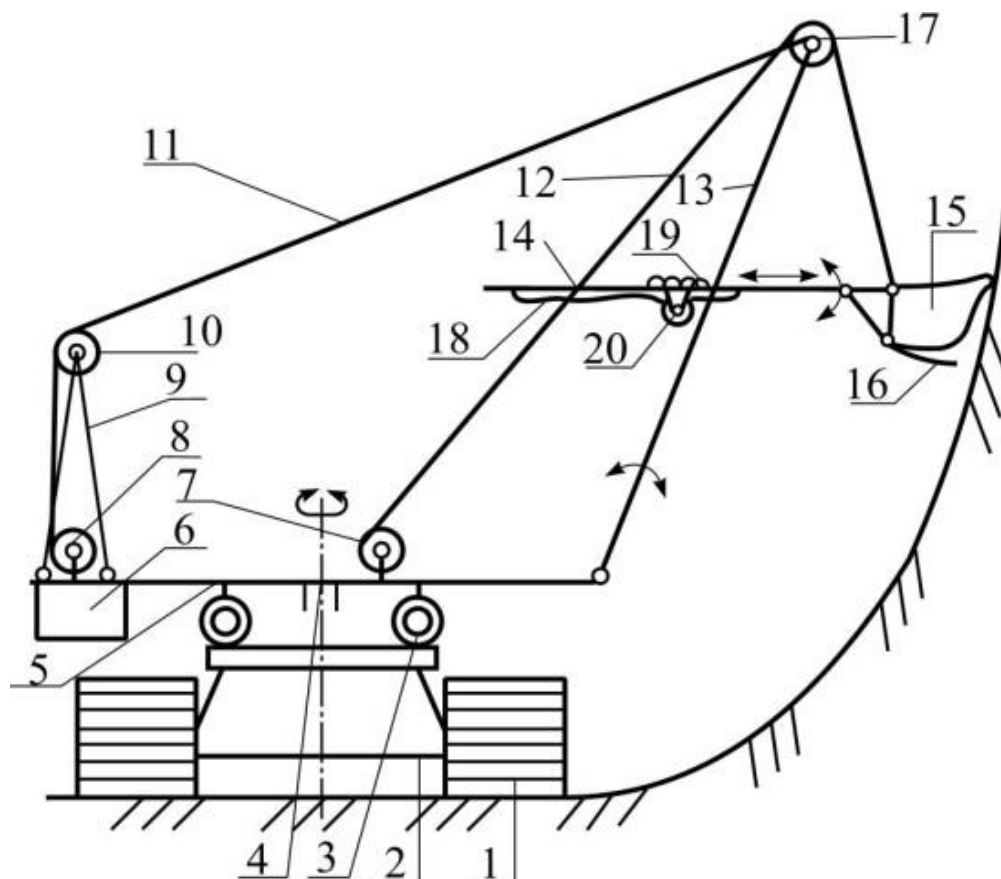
Принципова схема екскаватора з гнучкою підвіскою робочого обладнання: 1 – гусениця; 2 – рама; 3 – кульовий опорно-поворотний пристрій; 4 – центральна цапфа; 5 – поворотна платформа; 6 – противага; 7 – барабан підйомної лебідки; 9 – двонога стійка; 10 – направляючий блок; 11 – стріло підйомний канат; 12 – підйомний канат; 13 – стріла; 14 – держак; 15 – ківш; 16 – днище ковша; 17 – направляючий блок; 18 – кремальєрна рейка; 19 – підшипник; 20 – кремальєрна шестерня
